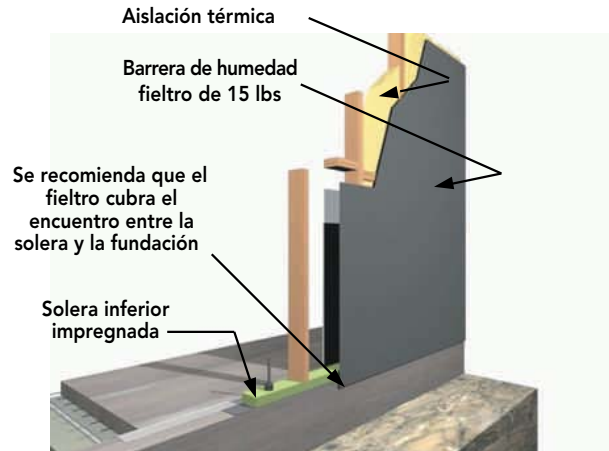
Se recomienda que la barrera de humedad pase al menos 50 mm el encuentro entre la solera inferior y la fundación.
